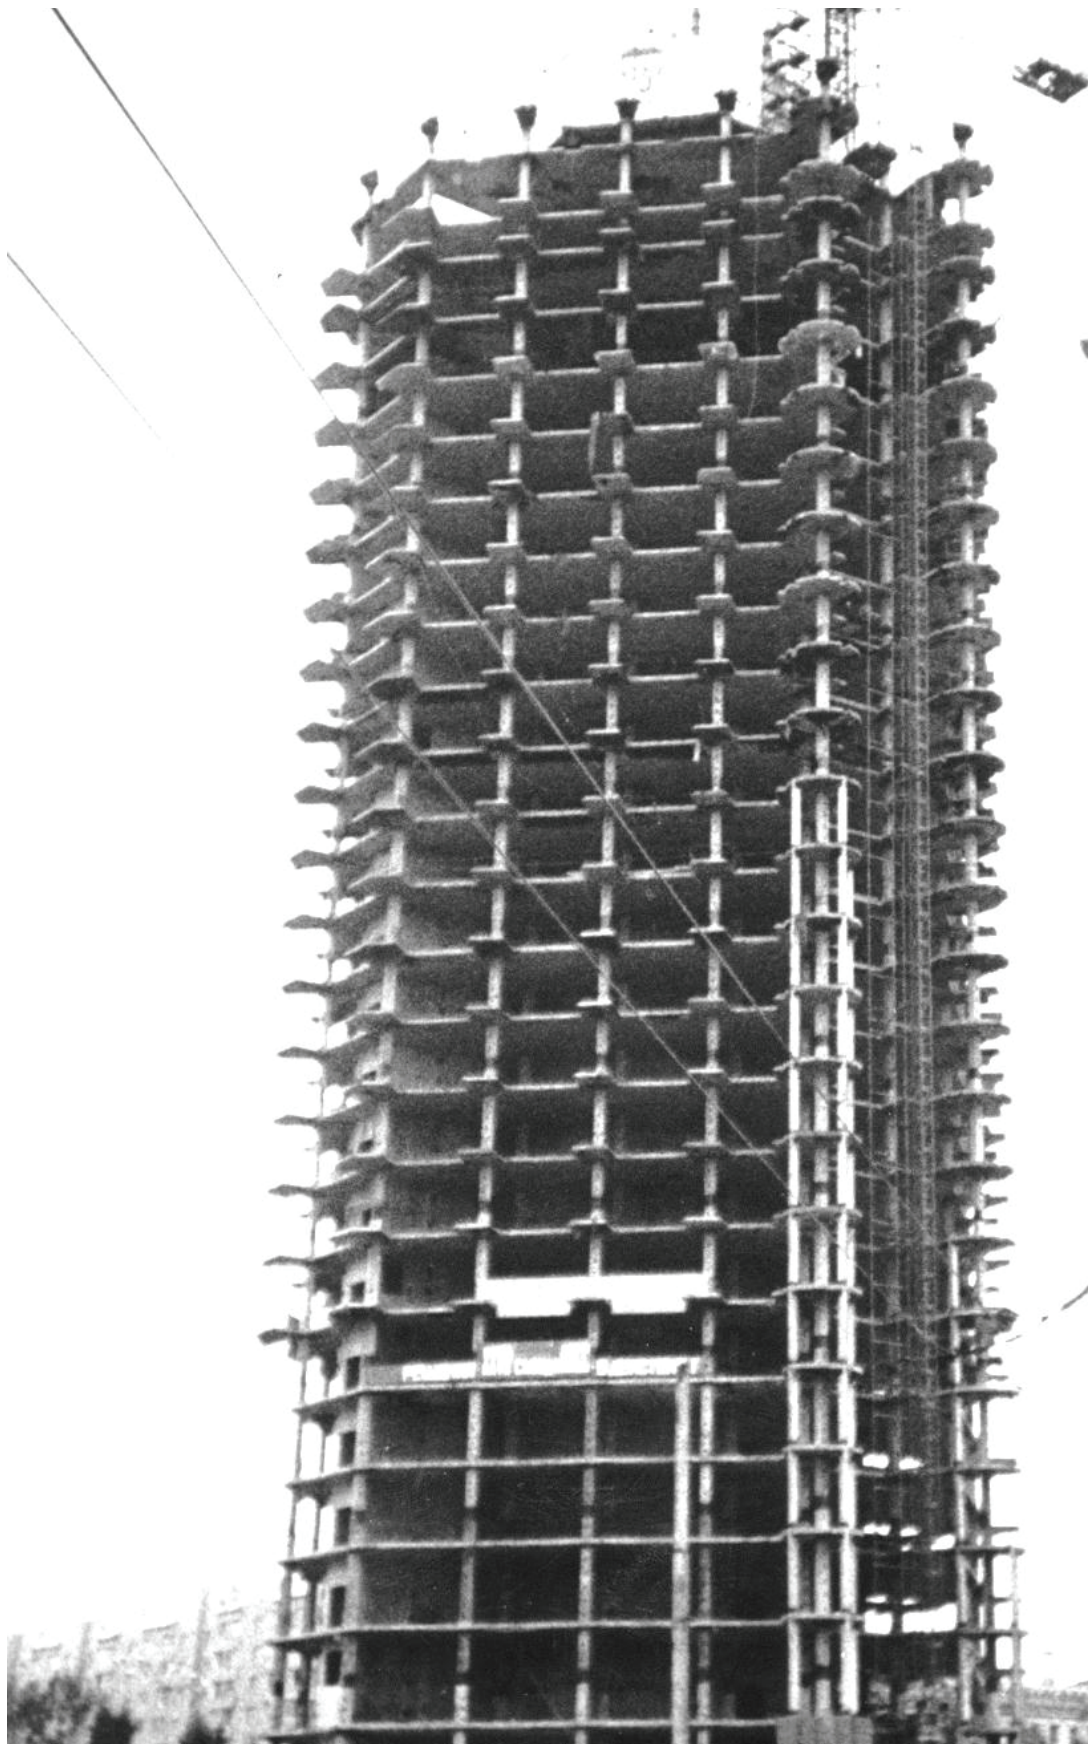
Устройство междуэтажных перекрытий и эвакуационных балконов с 6-го по 23-й этаж (июль 1986 г.)
